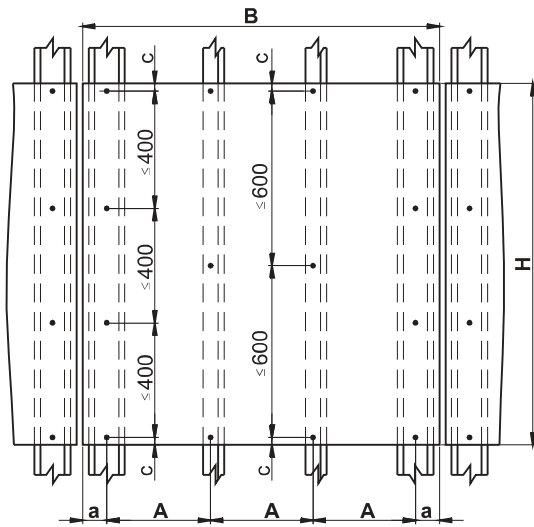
Схема крепления фиброцементной панели при высоте здания до 12 этажей. (вертикальная раскладка)
